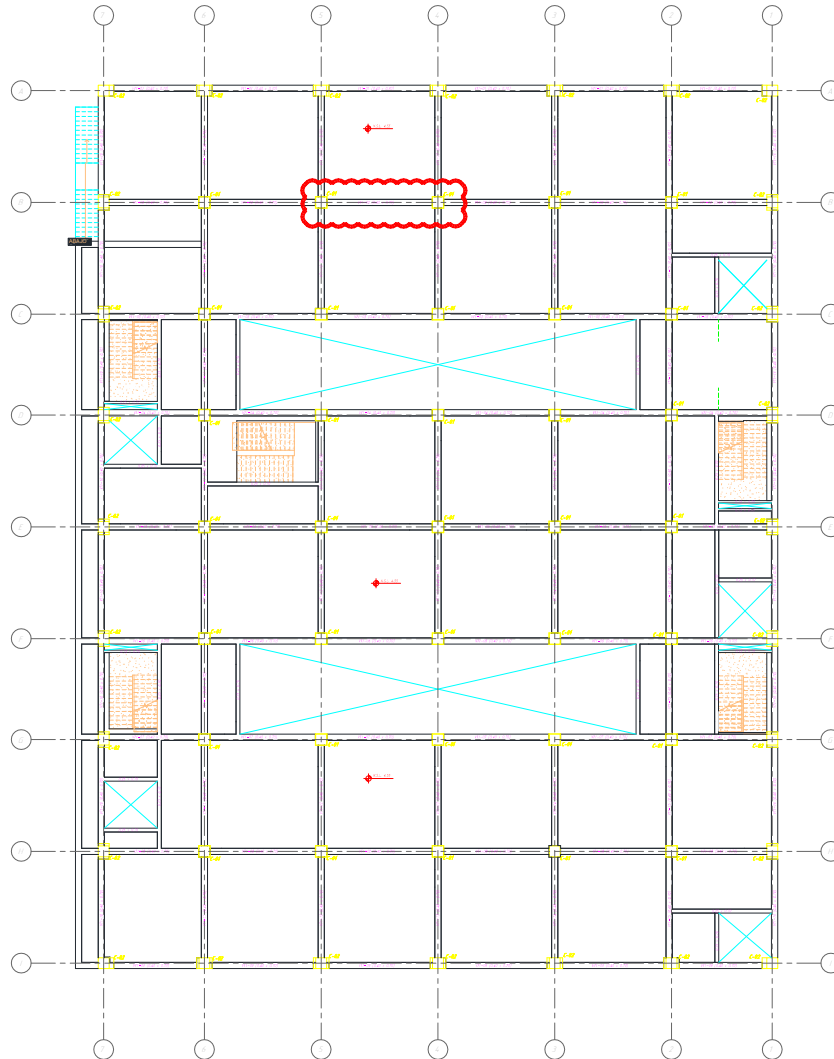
Tramo de viga VT1-02 (piso 1) (0.40x0.70m)
